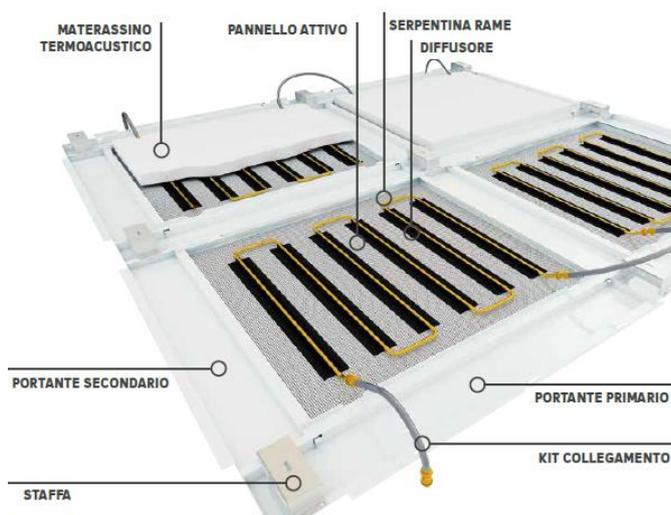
Schema funzionale pannelli radianti a controsoffitto
